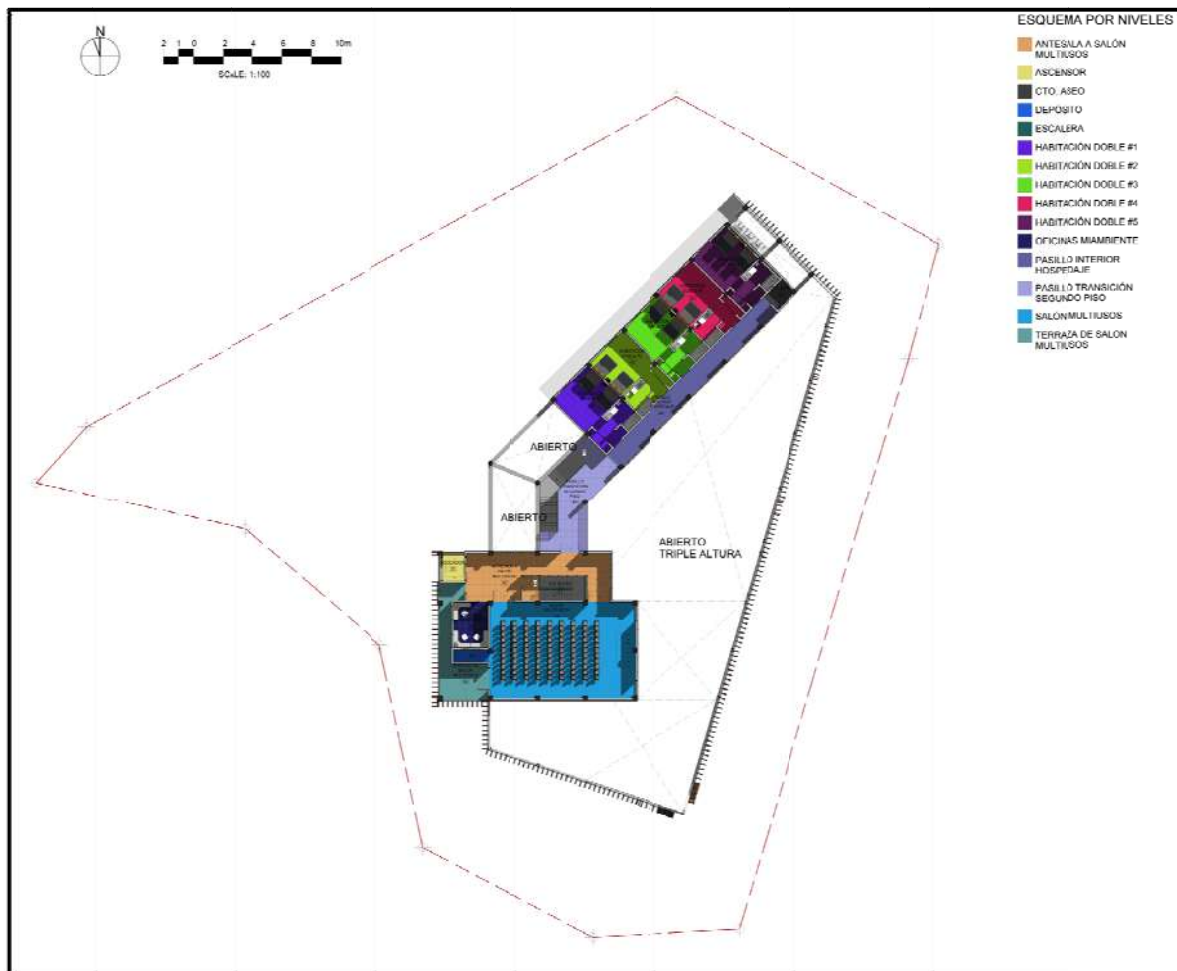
PLANTA ARQUITECTÓNICA N.100 SEGÚN ESPACIOS
